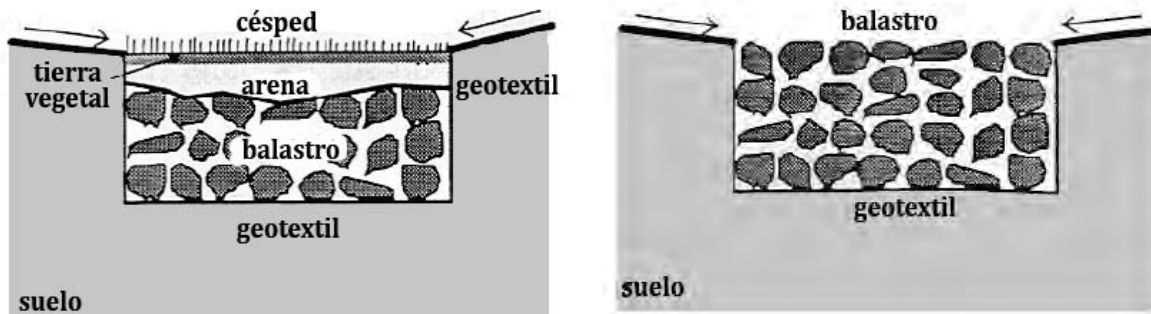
EJEMPLOS DE TRINCHERAS APARENTES O RECUBIERTAS
